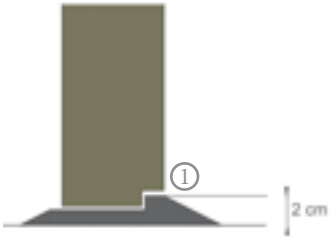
4 Desniveles < 2 cm - Alzado
